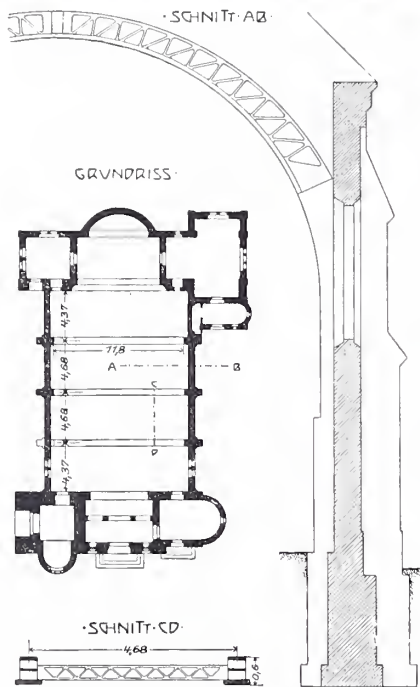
Evang. Kirche in Aussig a. E. Grundriß und Schnitt.
